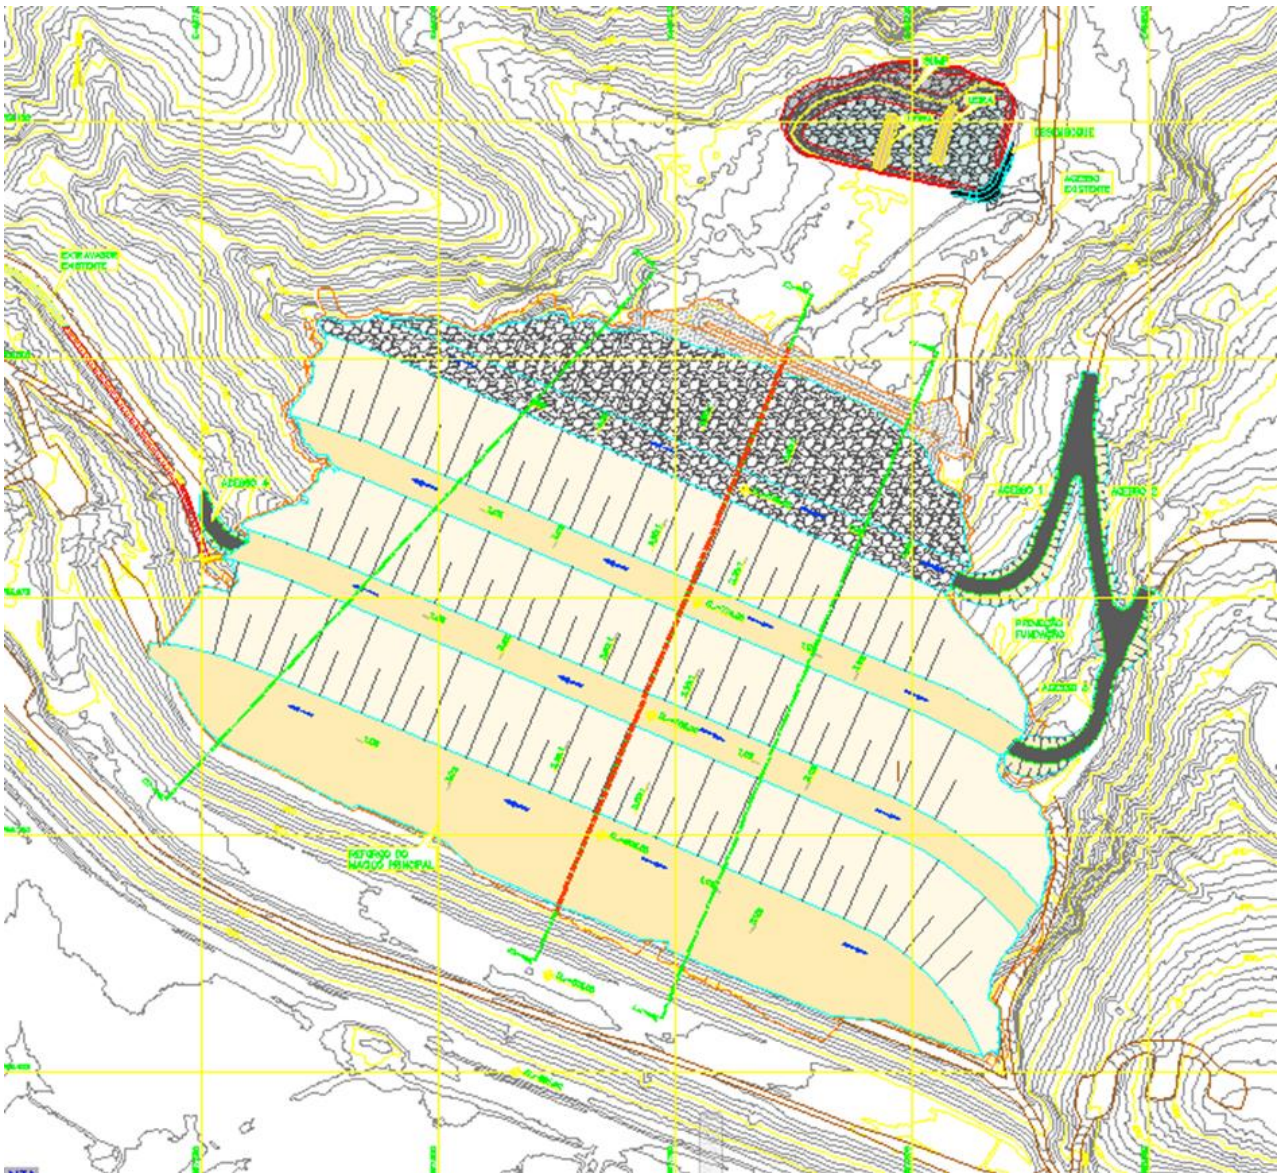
Reforço de descaracterização da Barragem Doutor – Planta.
